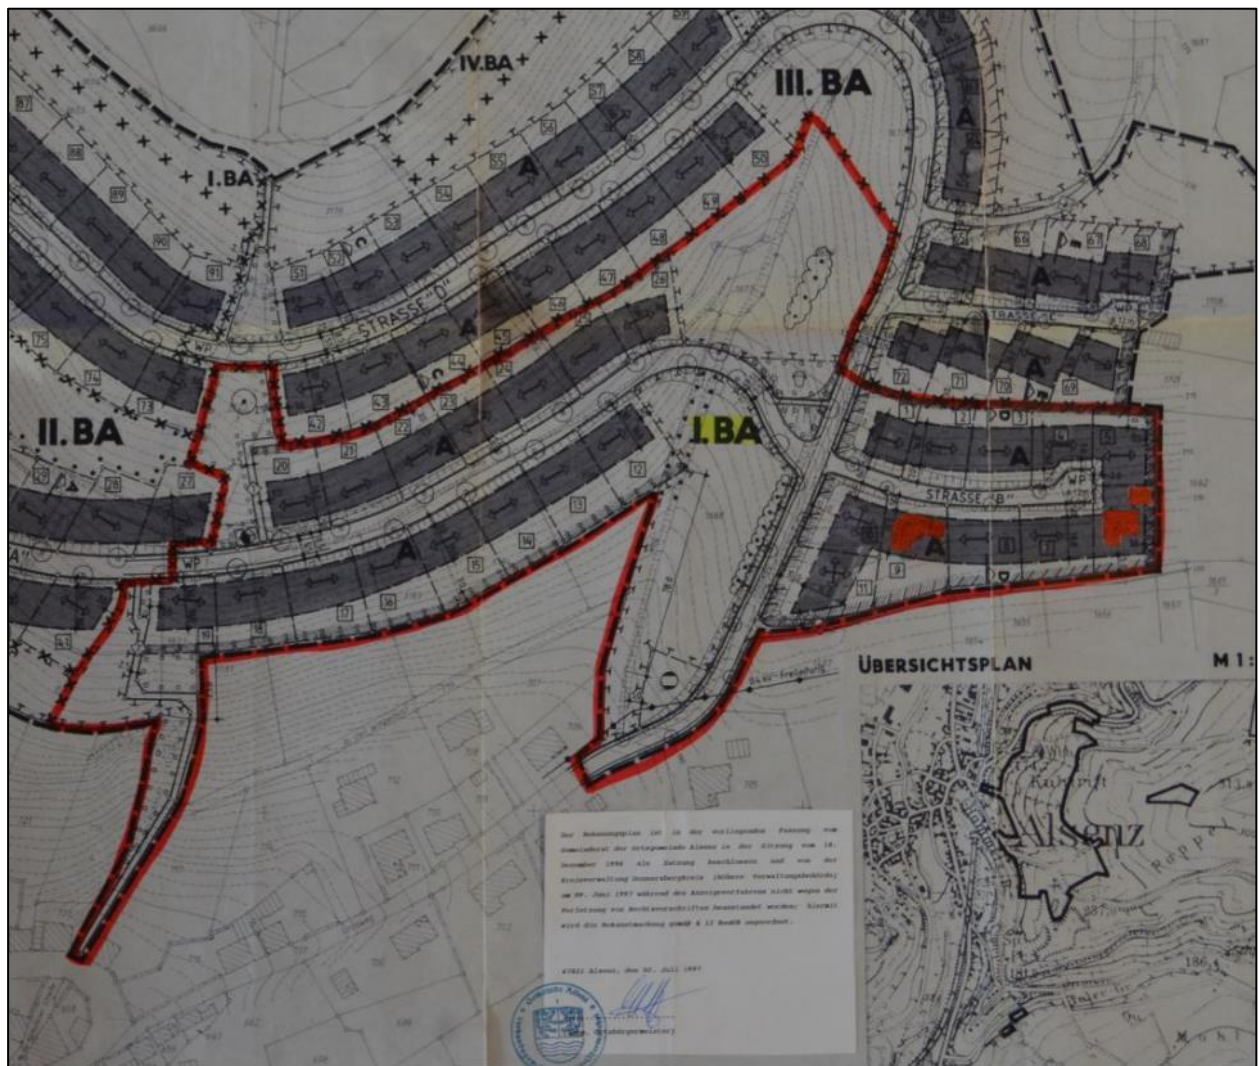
Bebauungsplan „An der Kühtrift“, Alsenz, Plan nicht genordnet
